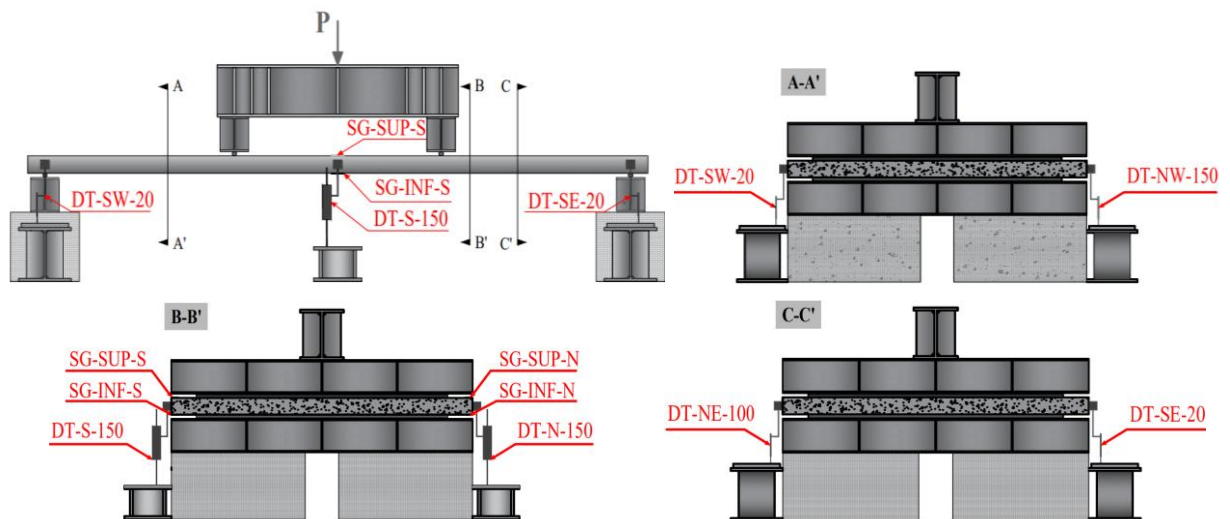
Ensaio experimental das lajes de concreto pré-moldado envelopadas (LBE/UFV).
